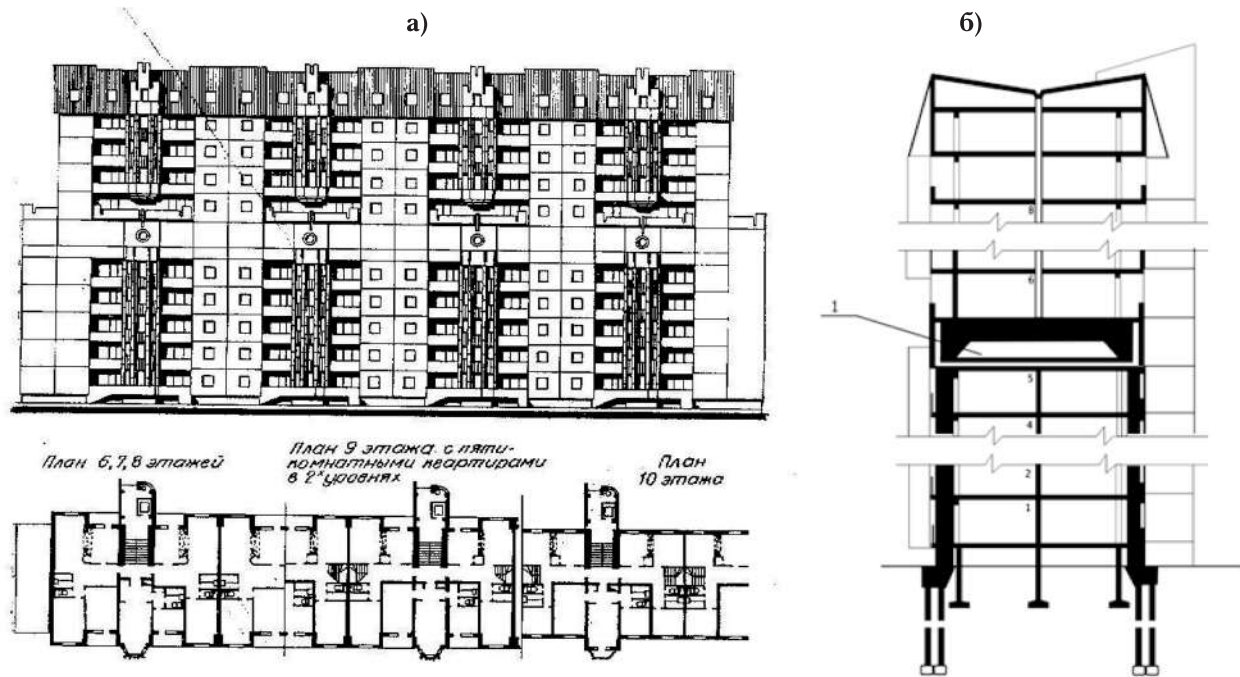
Конструктивна система «Фламінго»: реконструкції будинку серії 1-480: а – фасад та плани надбудованих поверхів [9,12] б – принципова конструктивна схема реконструкції [9]; 1 – технічний поверх
